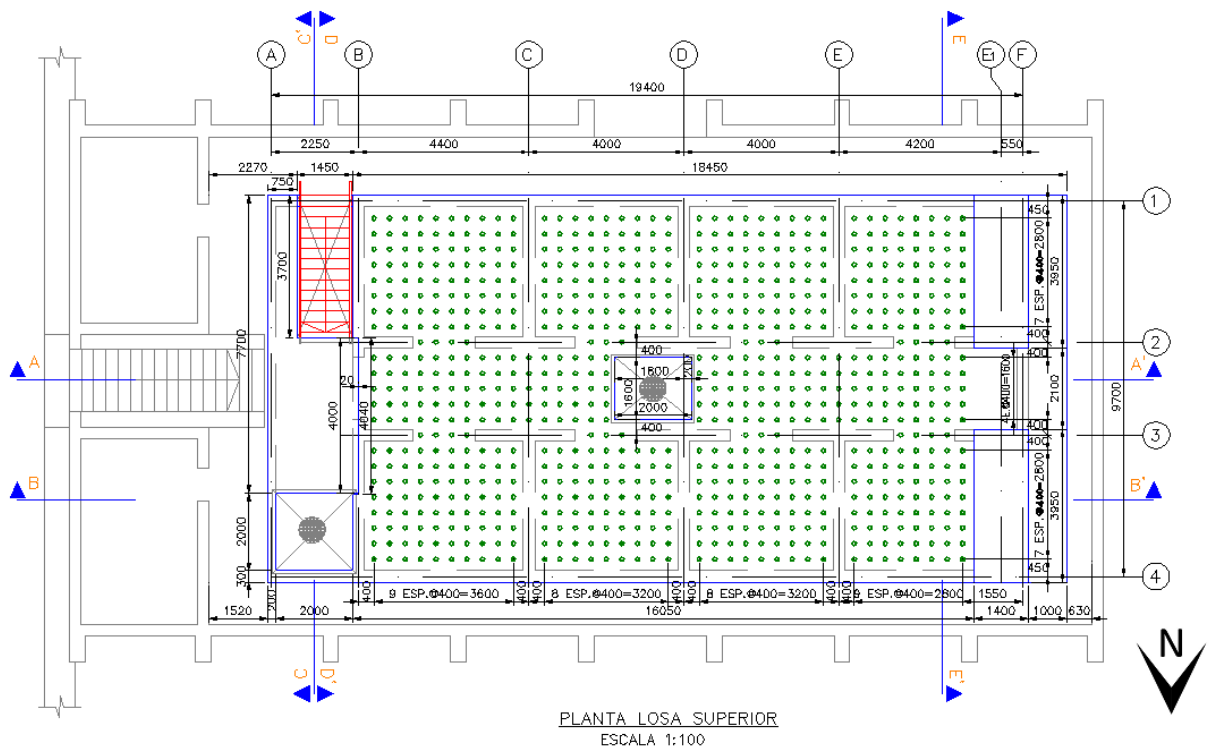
Plano general Laboratorio de Estructuras.
